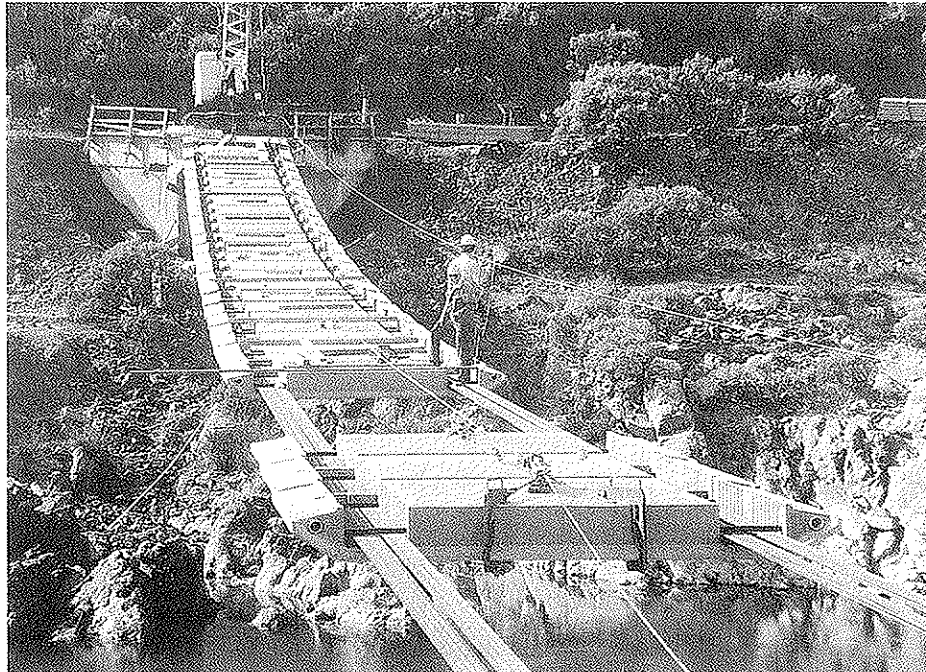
Proceso constructivo en la pasarela de Sacramento [5].
